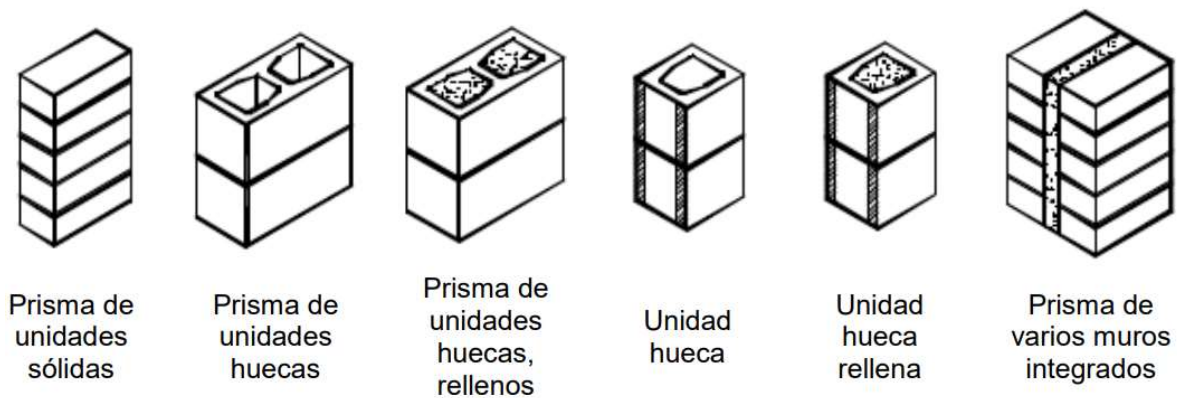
Esquema de la mampostería de concreto reforzada
